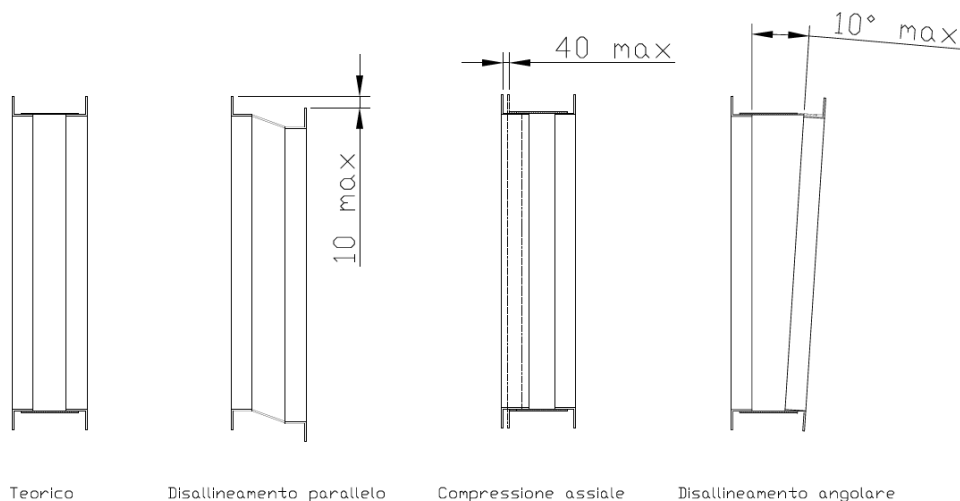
Tolleranze di montaggio dei giunti flessibili
